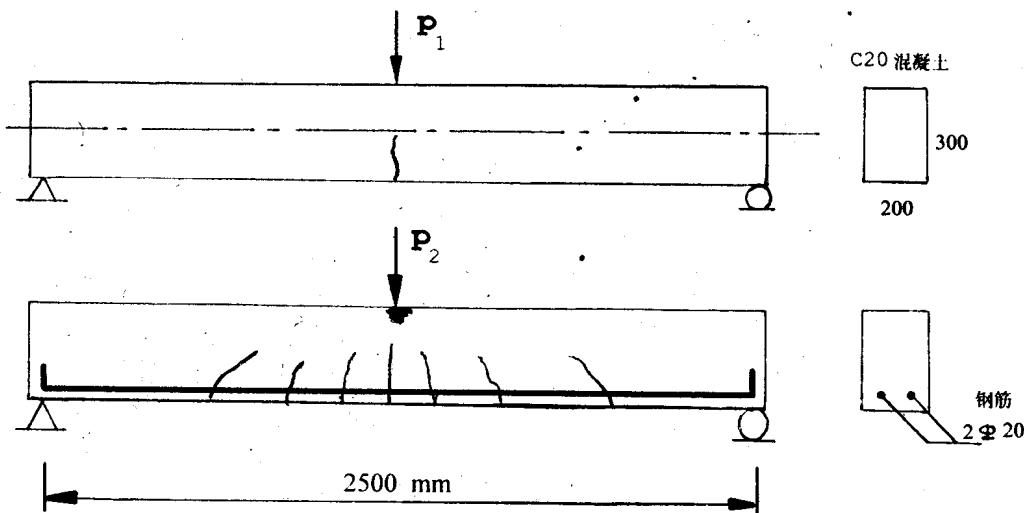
纯混凝土梁和钢筋混凝土梁的破坏
